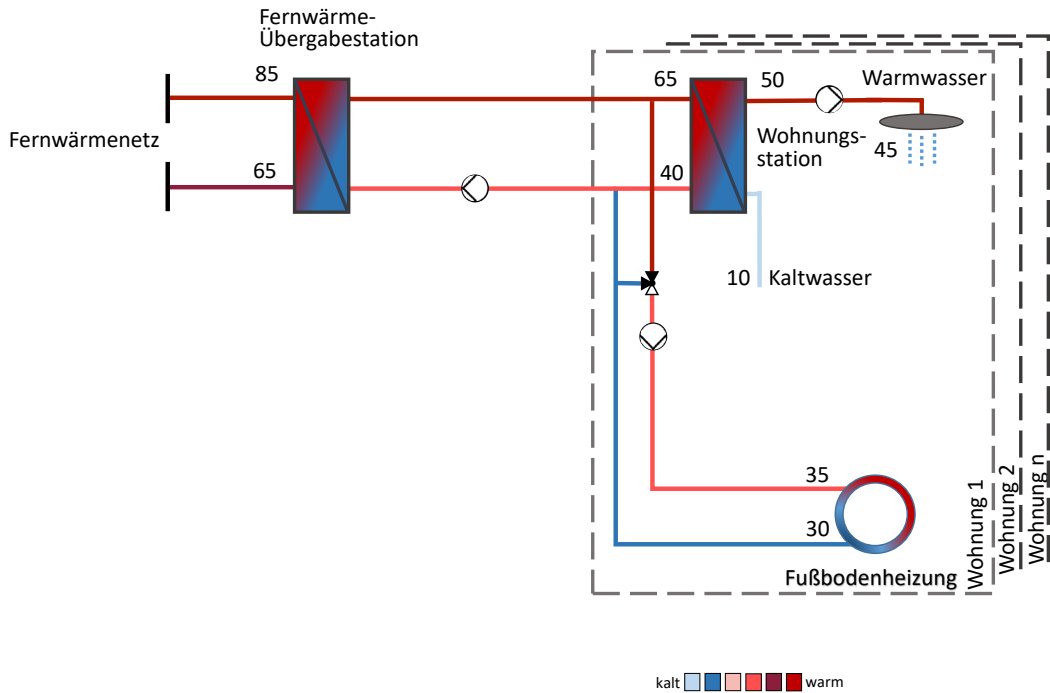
Vereinfachtes Haustechnikschema des Projekts Team³ in München mit Fernwärmeanschluss, Zweileiter-Verteilssystem und Fußbodenheizung
